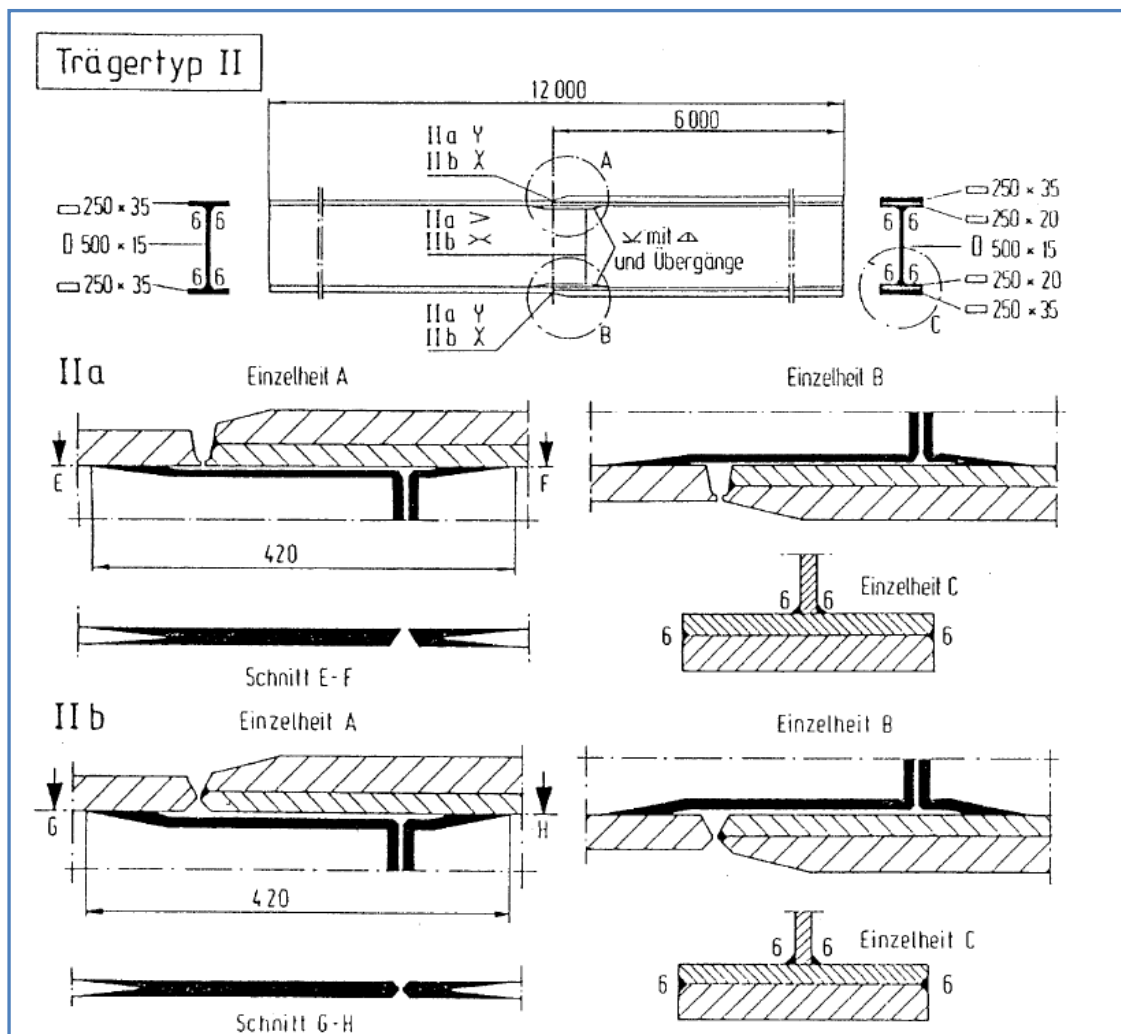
Schweißnahtdetails, Schwingversuche BAM 164 [46]
